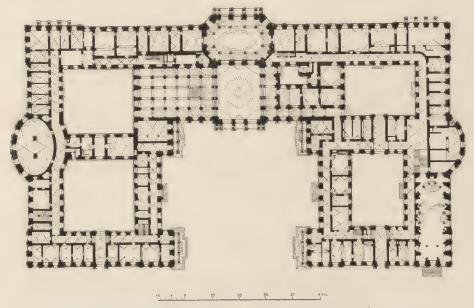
Residenz zu Würzburg. Grundriss des Erdgeschosses.
